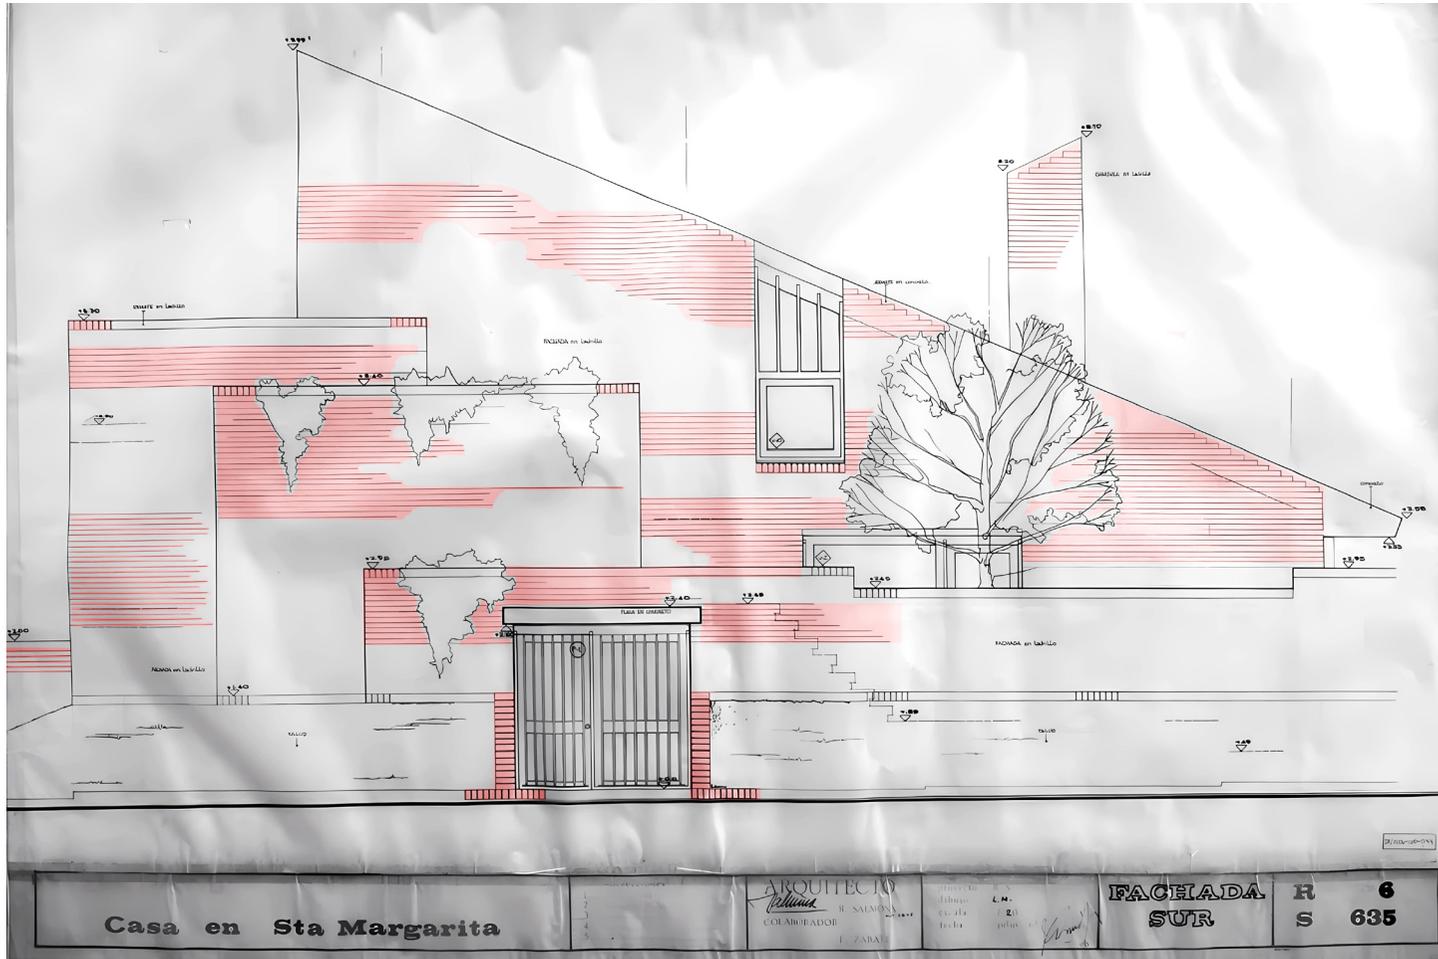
Fachada sur de la Casa en Santa Margarita - JR Z006-01D-044 (JULIO DE 1965). En el plano las líneas horizontales representan las hiladas del ladrillo,
